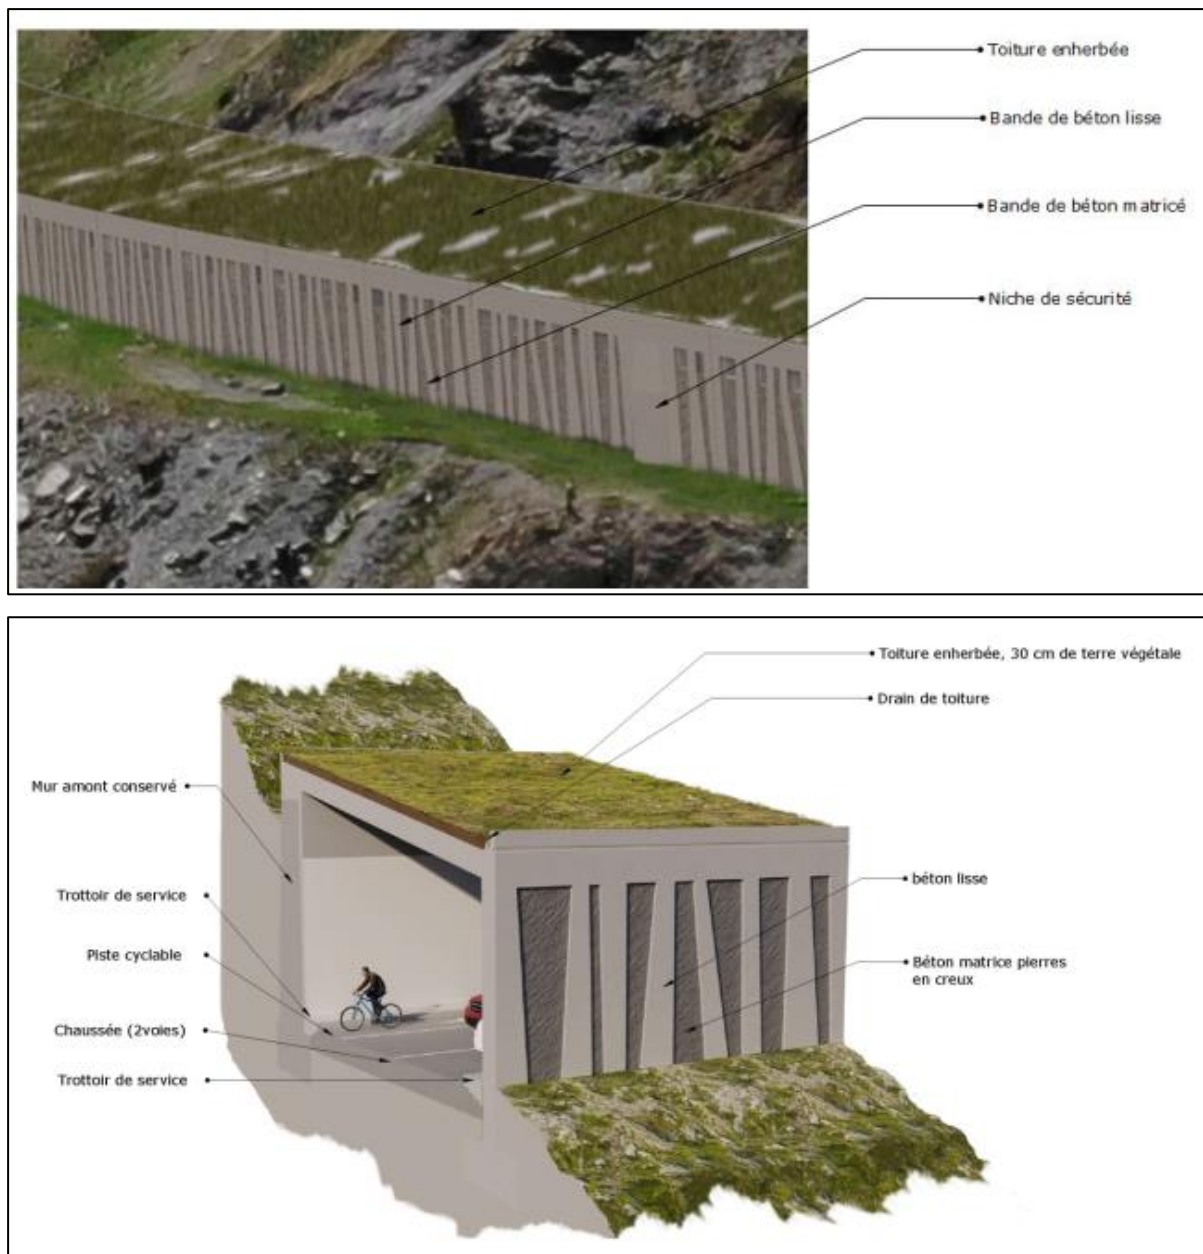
Illustration du projet : principe de parement du mur aval (en haut) et croquis en coupe perspective (en bas) (source : Lavigne Chéron Architectes)
